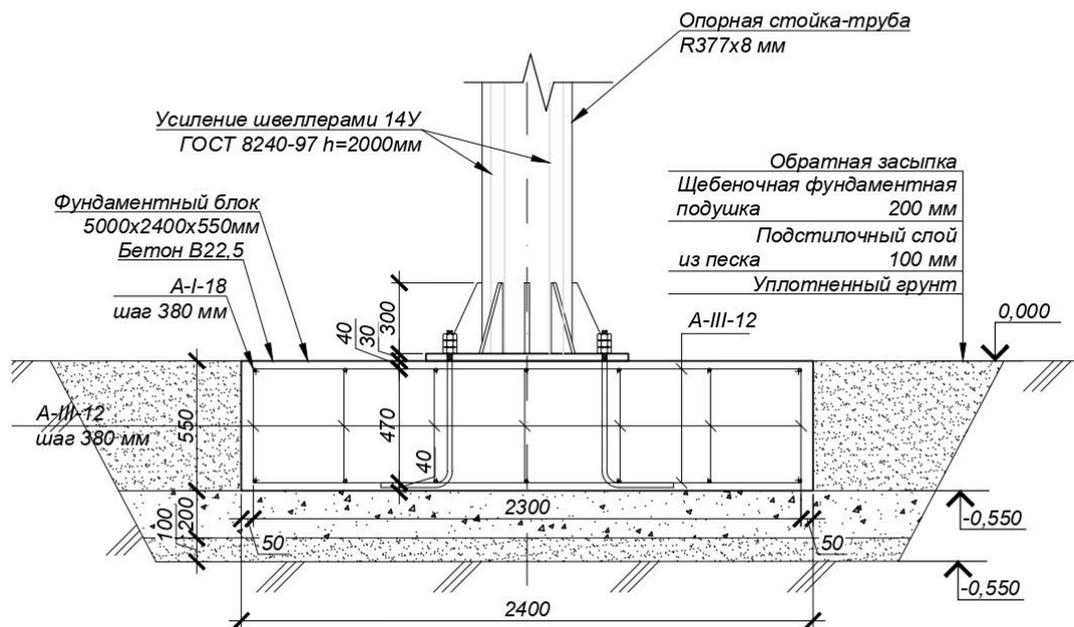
Узел фундамента стойки рекламного стенда сити-сайт (3x6 м)
